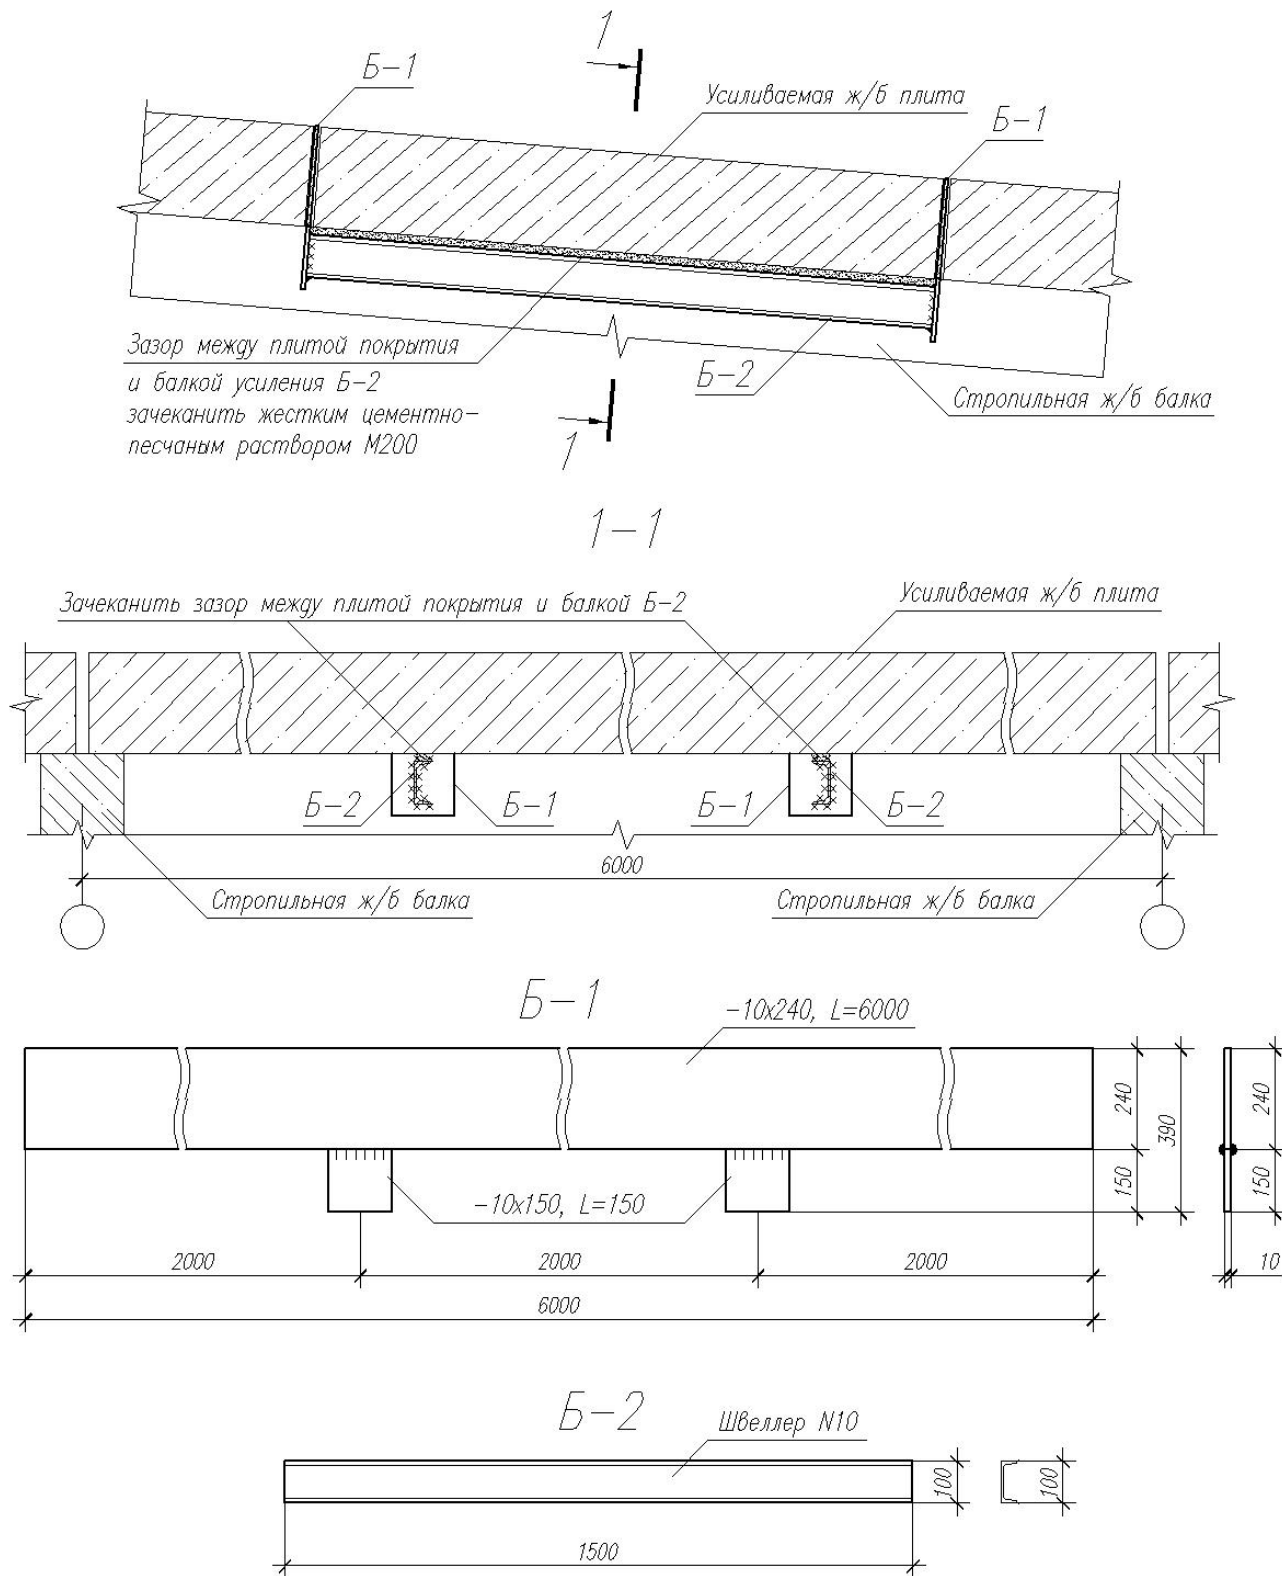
Конструкция усиления плит покрытия из ячеистого бетона
